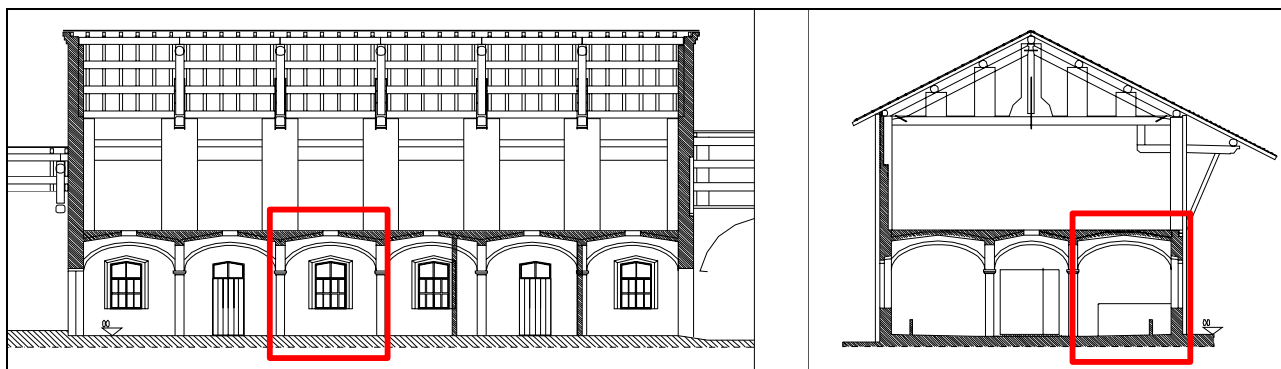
La stalla del complesso di villa Burba a Rho: sezioni longitudinale e trasversale con individuazione dell'area sottoposta a prove di carico.
